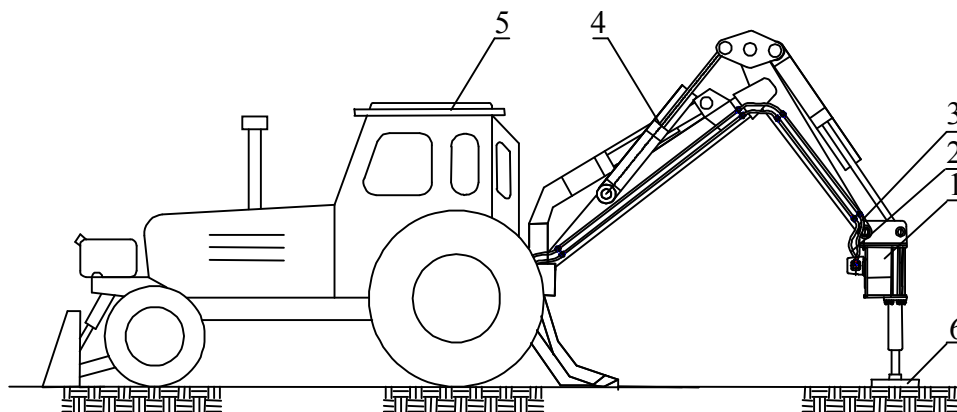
Общий вид отбойного агрегата с механическим молотом:
